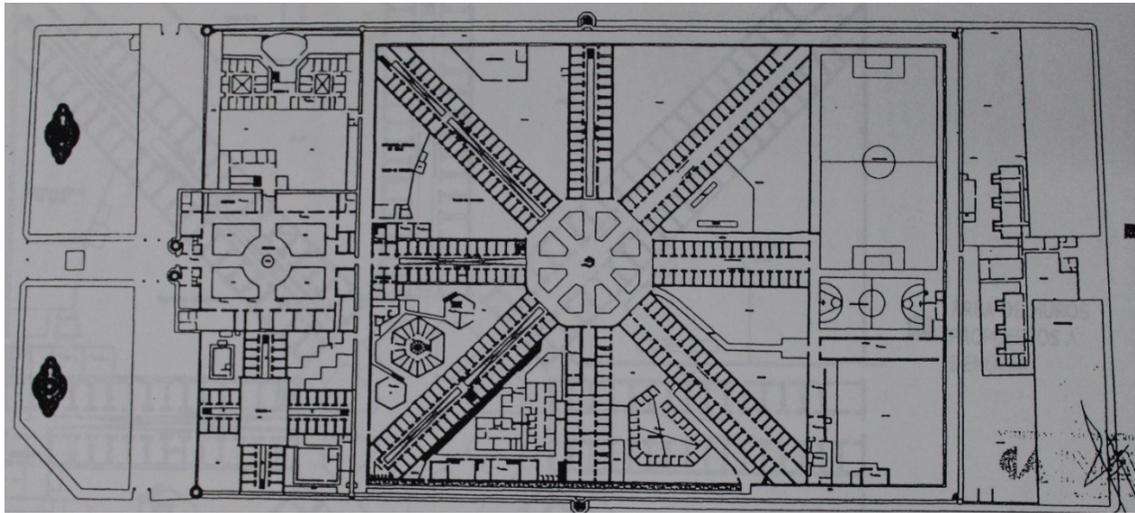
, Planta de conjunto donde se aprecia el inmueble previo al proyecto de intervención. En la esquina inferior izquierda el pabellón de procesados el cual posteriormente se convierte en el Museo Leonora Carrington.¹⁰²
